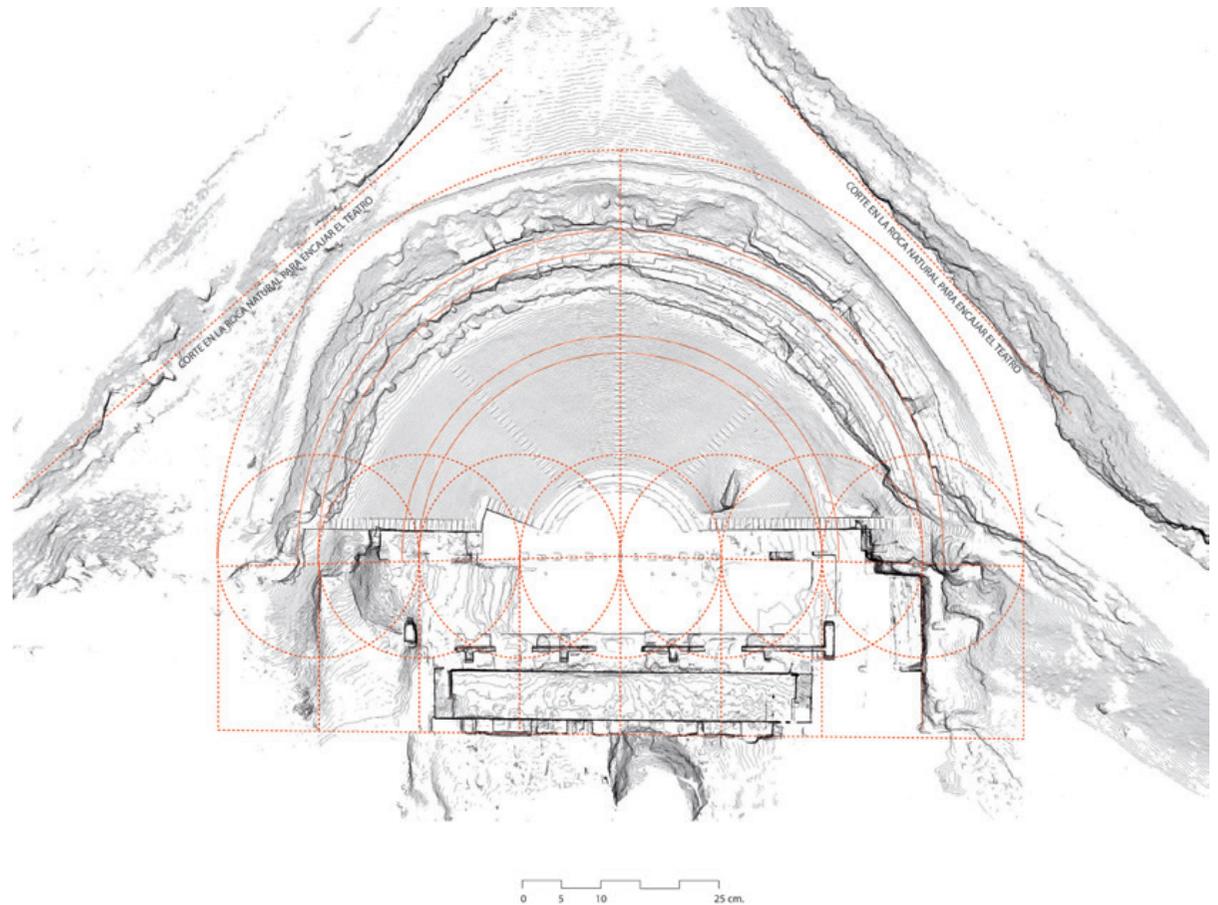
Planta del teatro y su geometría básica tras las campañas de 2008.
